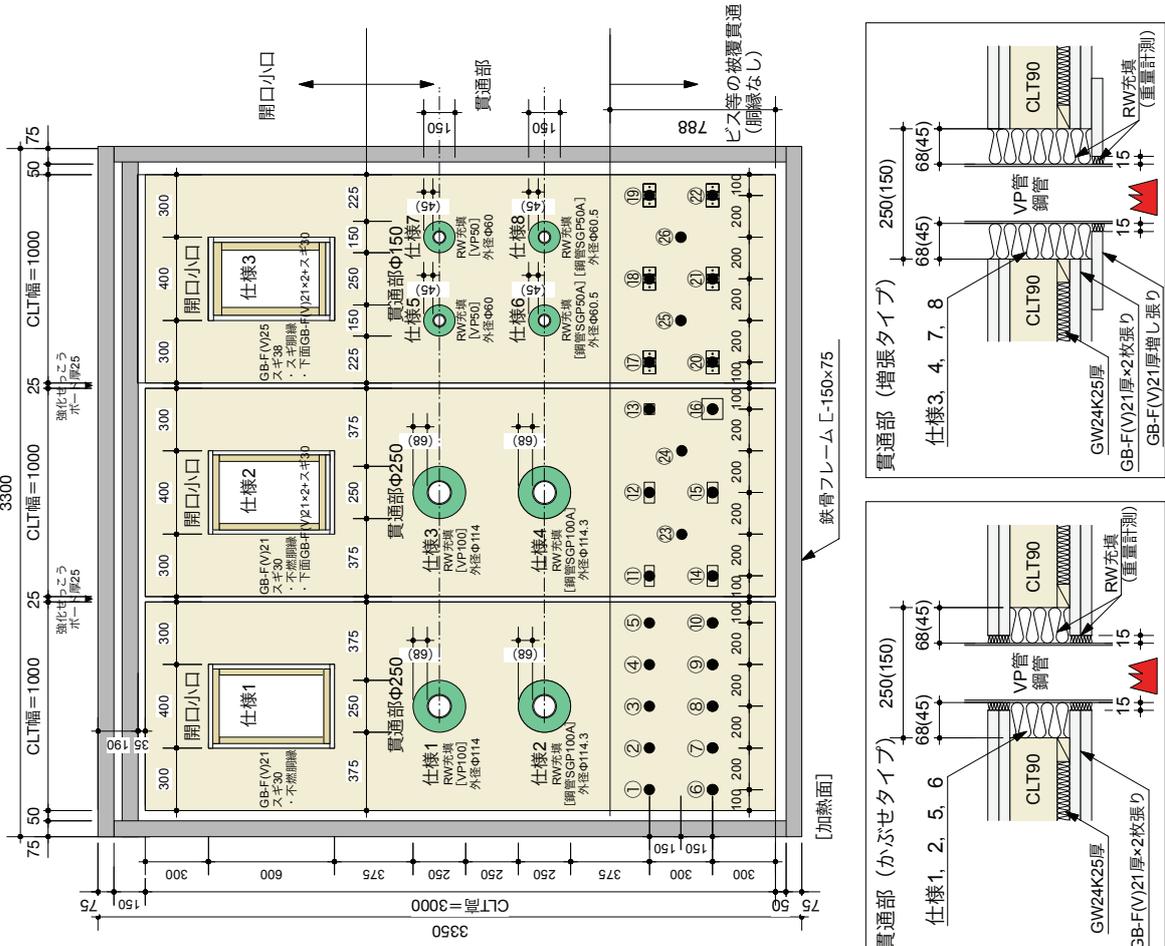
試験体 1 の構造・寸法 (単位: mm)
